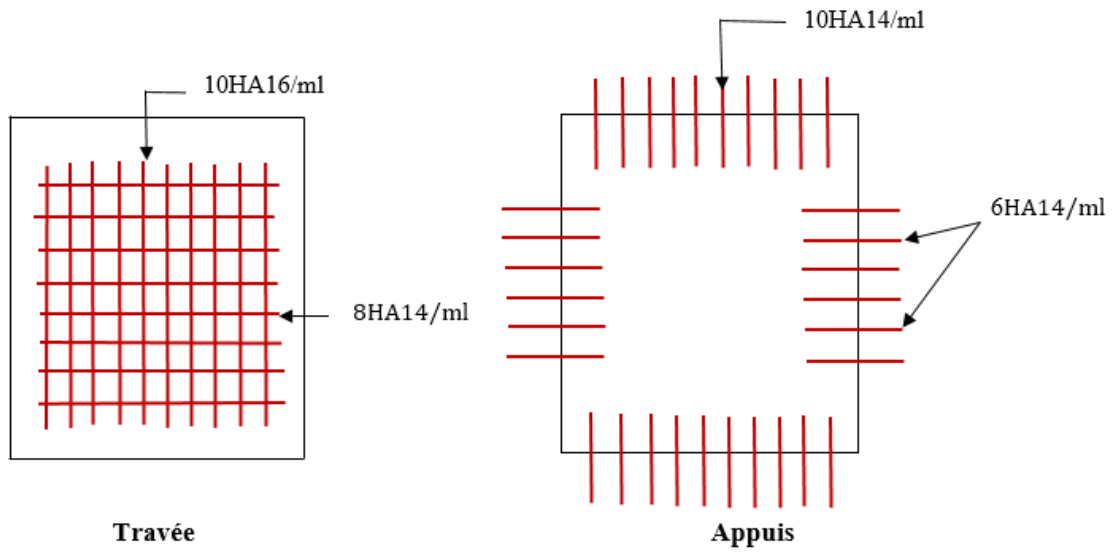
Schéma de ferrailage d'un panneau intermédiaire.
